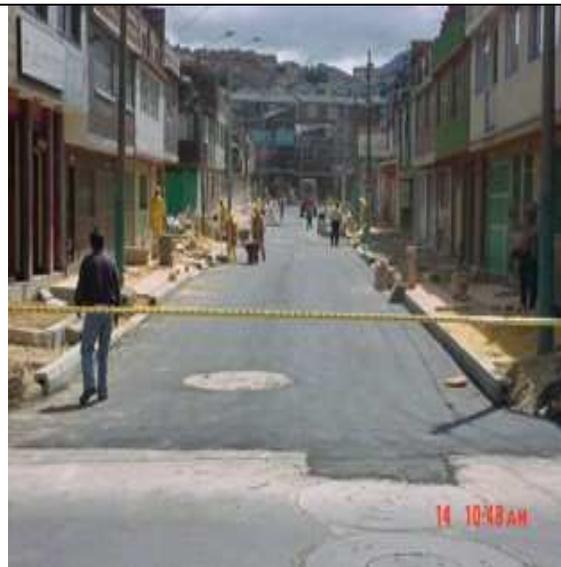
Se muestra la Kra 6 entre Cl. 50ª hasta la Dg. 49G sur pavimentada.
